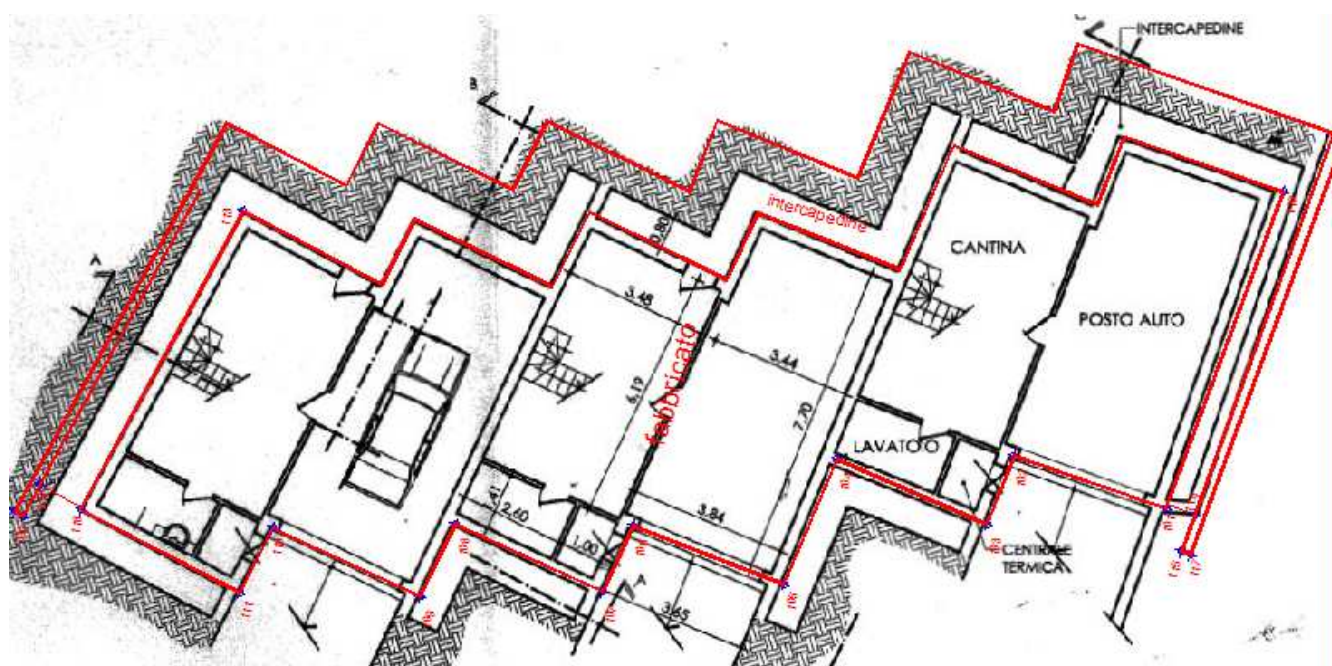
Piano seminterrato - Sovrapposizione tra progetto (linee nere) e rilievo strumentale (linee rosse)
